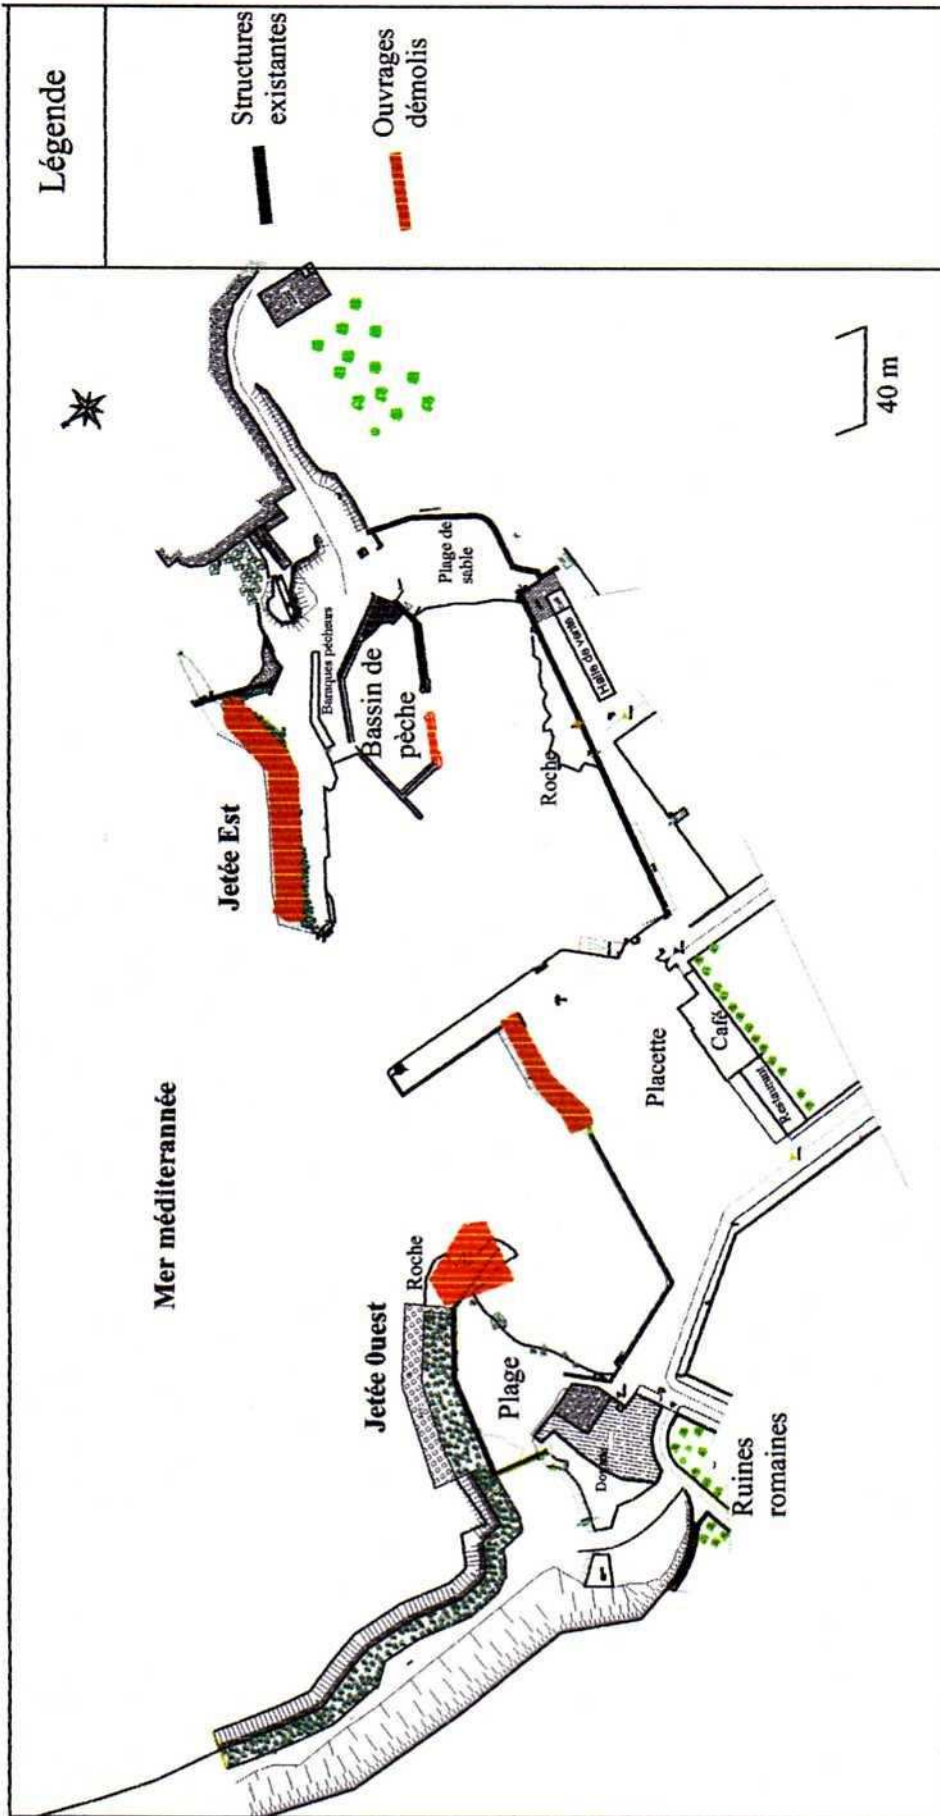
Plan des ouvrages démolis dans le port de Tipaza (2006).
